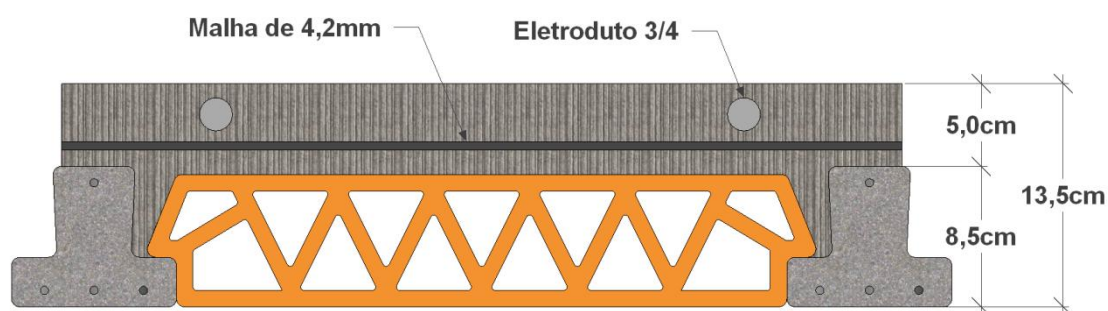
Dimensões de vigota e tabela cerâmica para montagem da laje protendida
